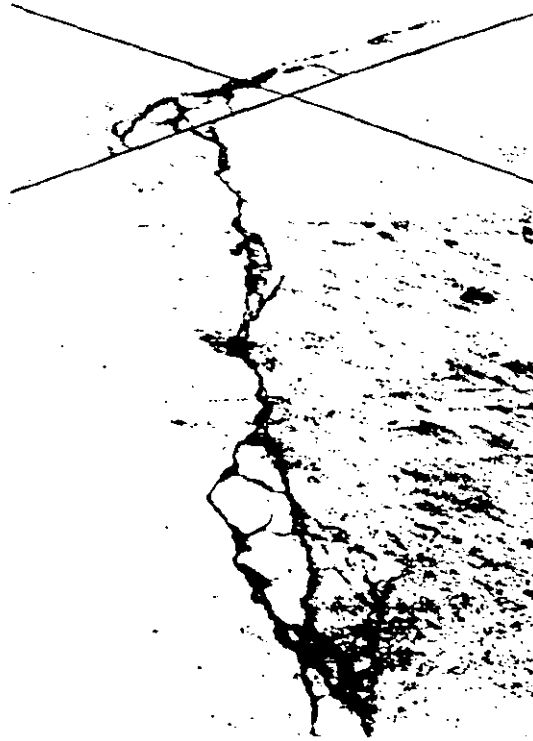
Grieta en diagonal y grietas en esquina. Fallo estructural debido probablemente a la falta de apoyo de las losas, subdrenaje defectuoso y a las cargas
